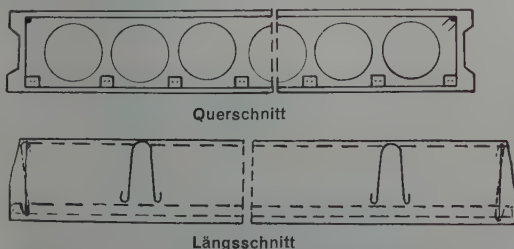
Deckenplatte Typ 170 K mit Spannstabbewehrung 1:20
